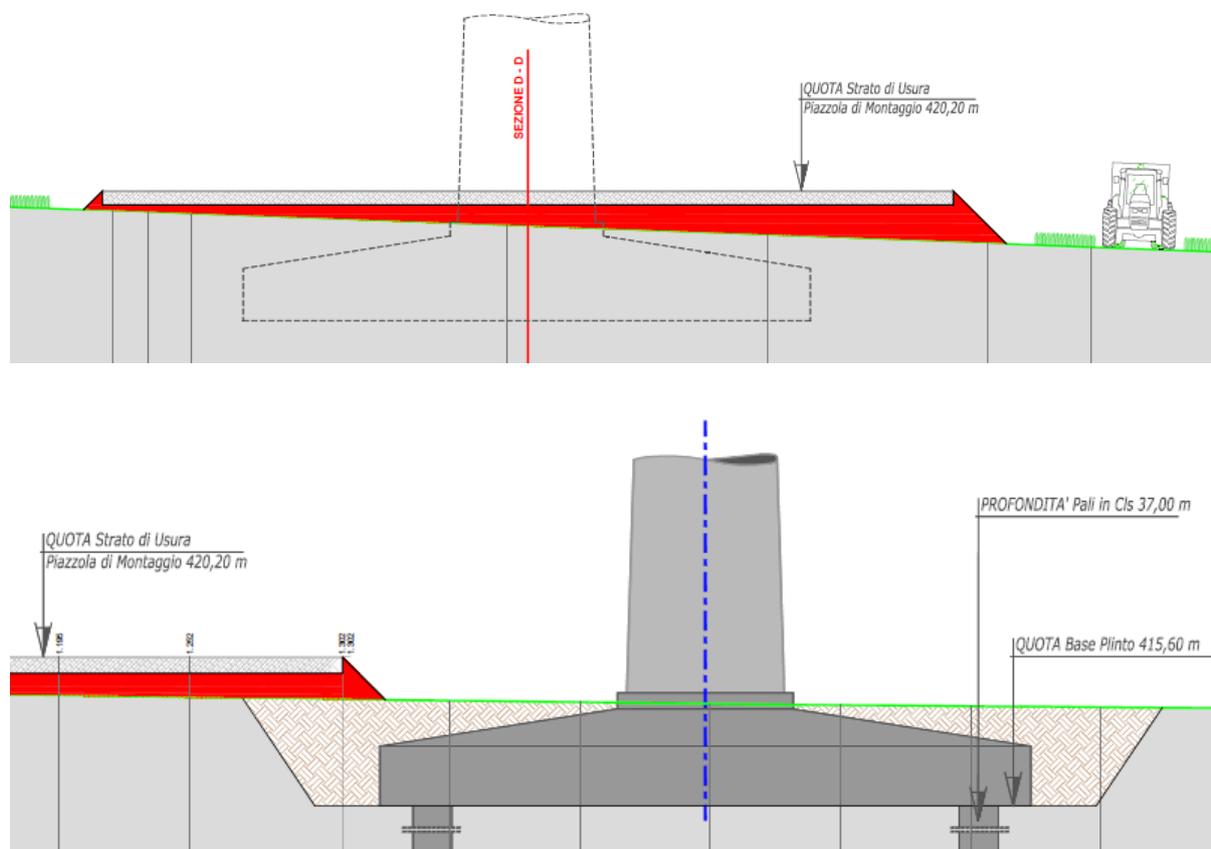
Esempio tipologico piazzola di montaggio e sezione di posa plinto fondazionale
